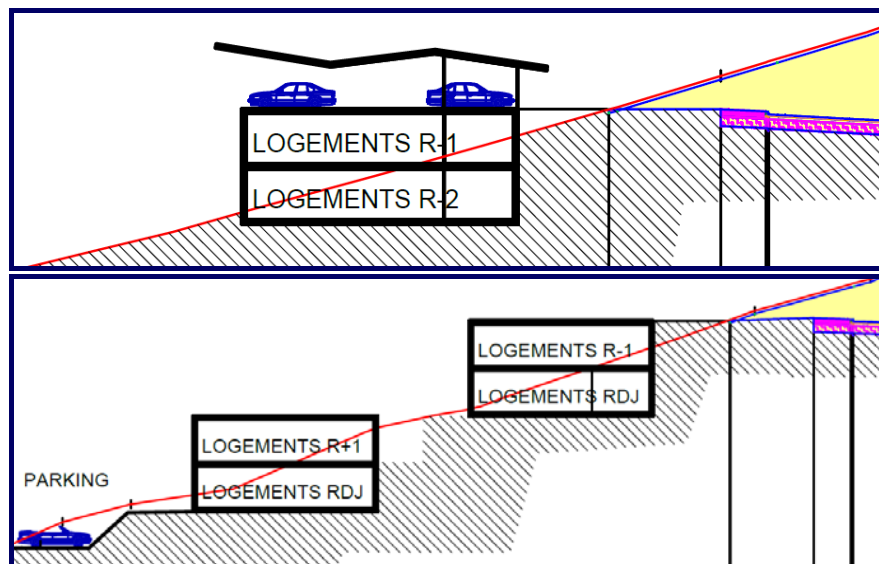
Profil type – Villas jumelée implantées en cohérence avec les contraintes topographiques (Source : ATELIER 13)
